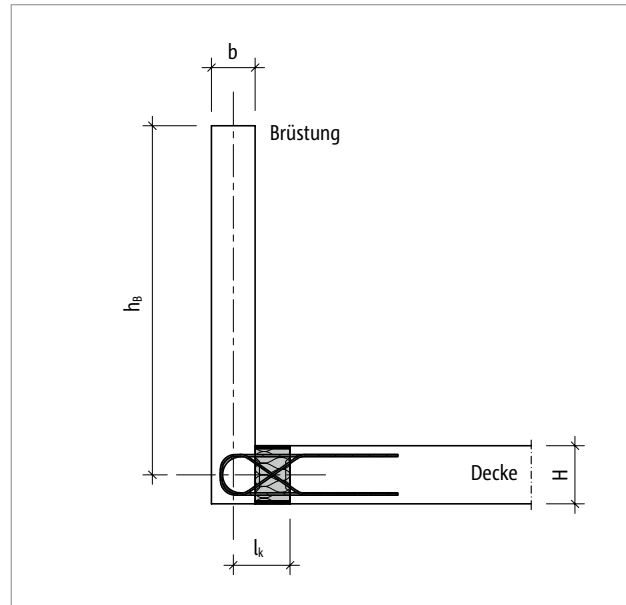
Schöck Isokorb® XT/T Typ AP: Statisches System Brüstungshöhe h_b
